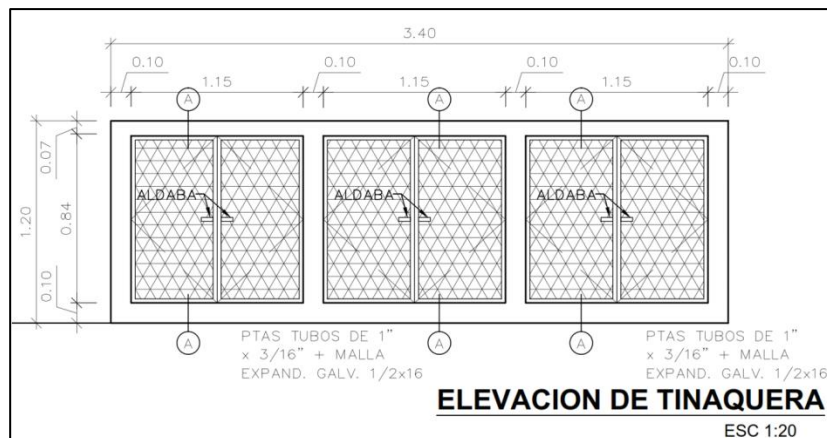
Planta de la tinaquera. Fuente: Planos de anteproyecto
